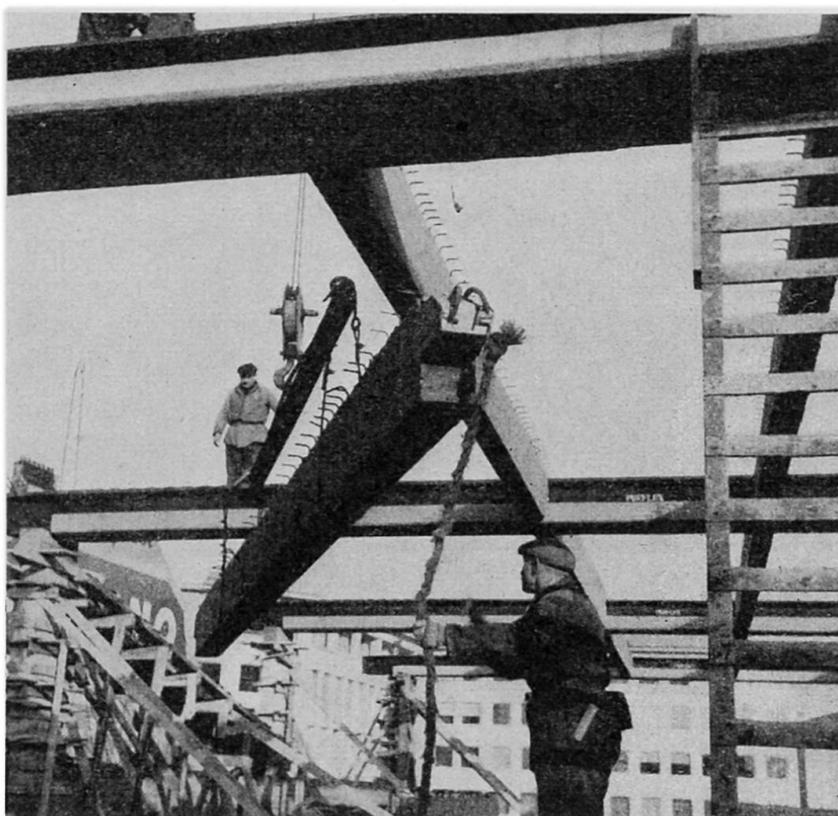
Office National du Placement et du Chomage à Bruxelles*. Mise en place des poutres préfabriquées en béton armé d'une longueur de 7,50 m sur les poutres Préflex ayant une portée de 15,00 m.
